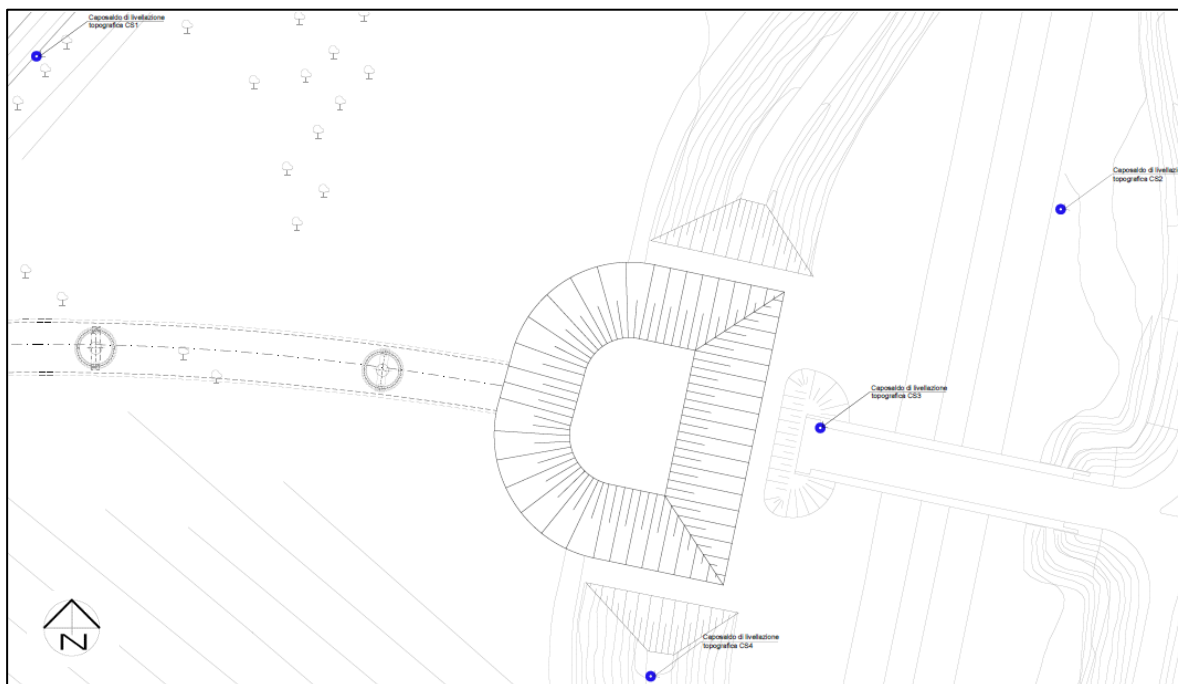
Stralcio planimetria ubicazione capisaldi
